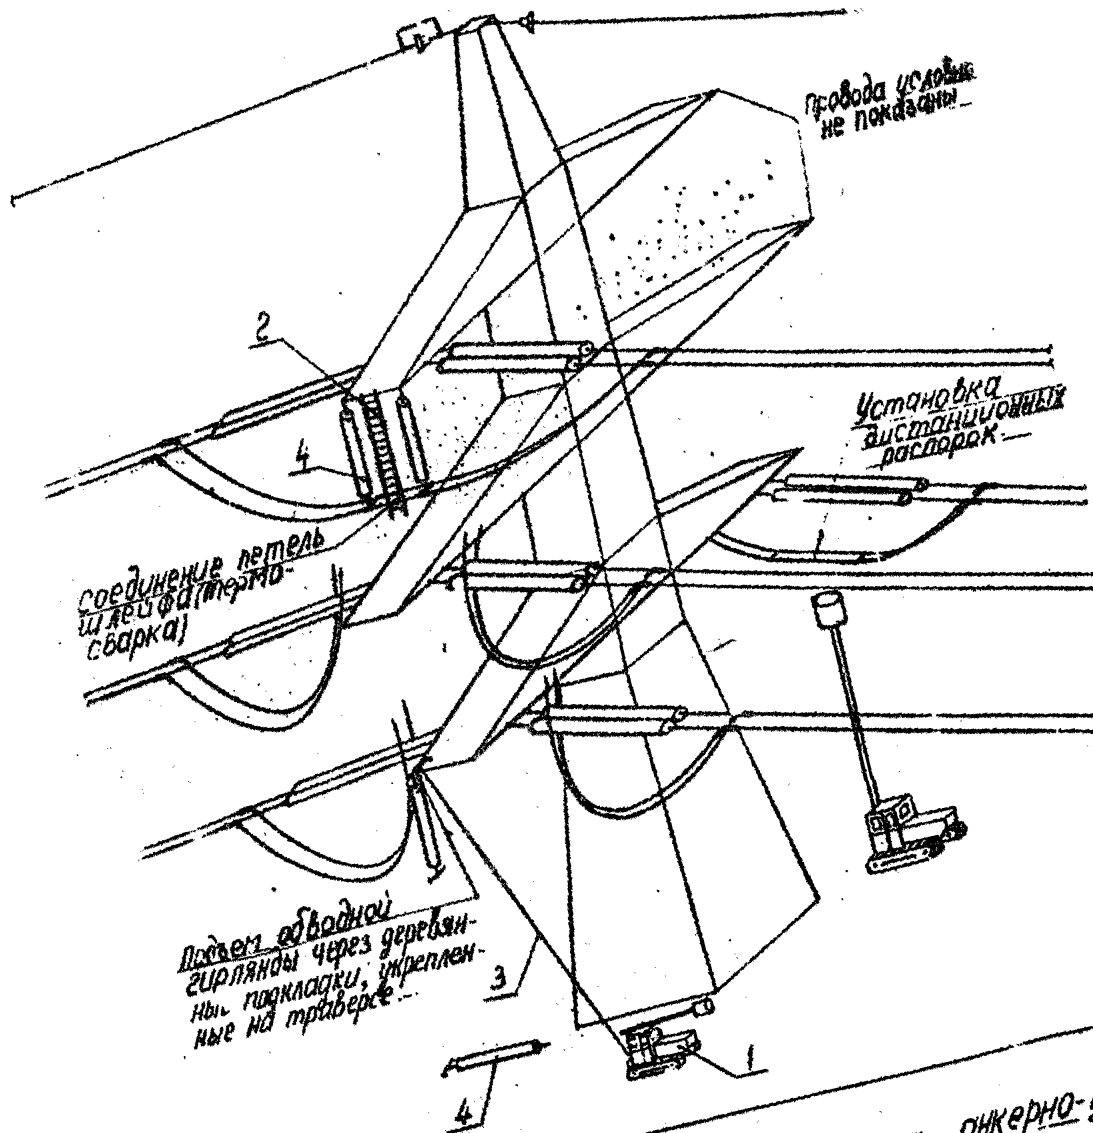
Монтаж петель шлейфа на анкерно-угловой опоре
